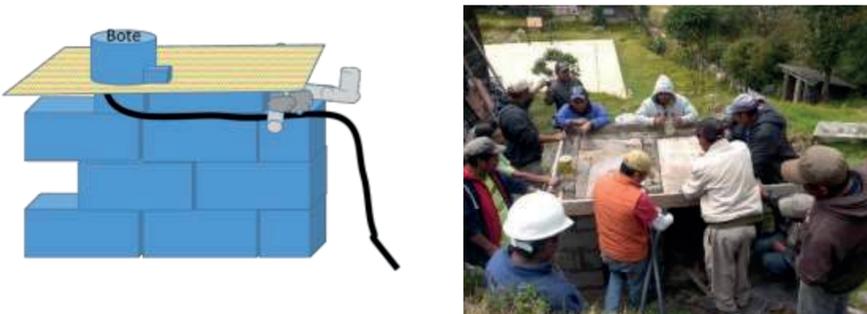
Mangueras de orina y armado de tubería de gases integrados a la losa
